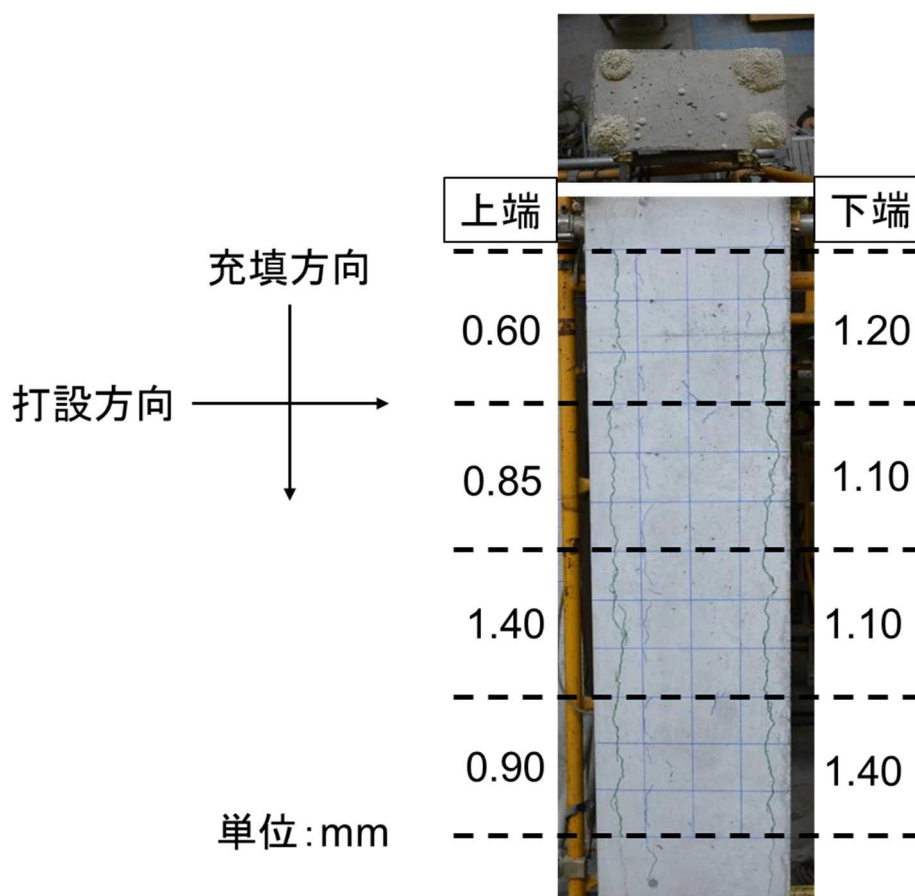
Monitor 試験体ひび割れ状況
